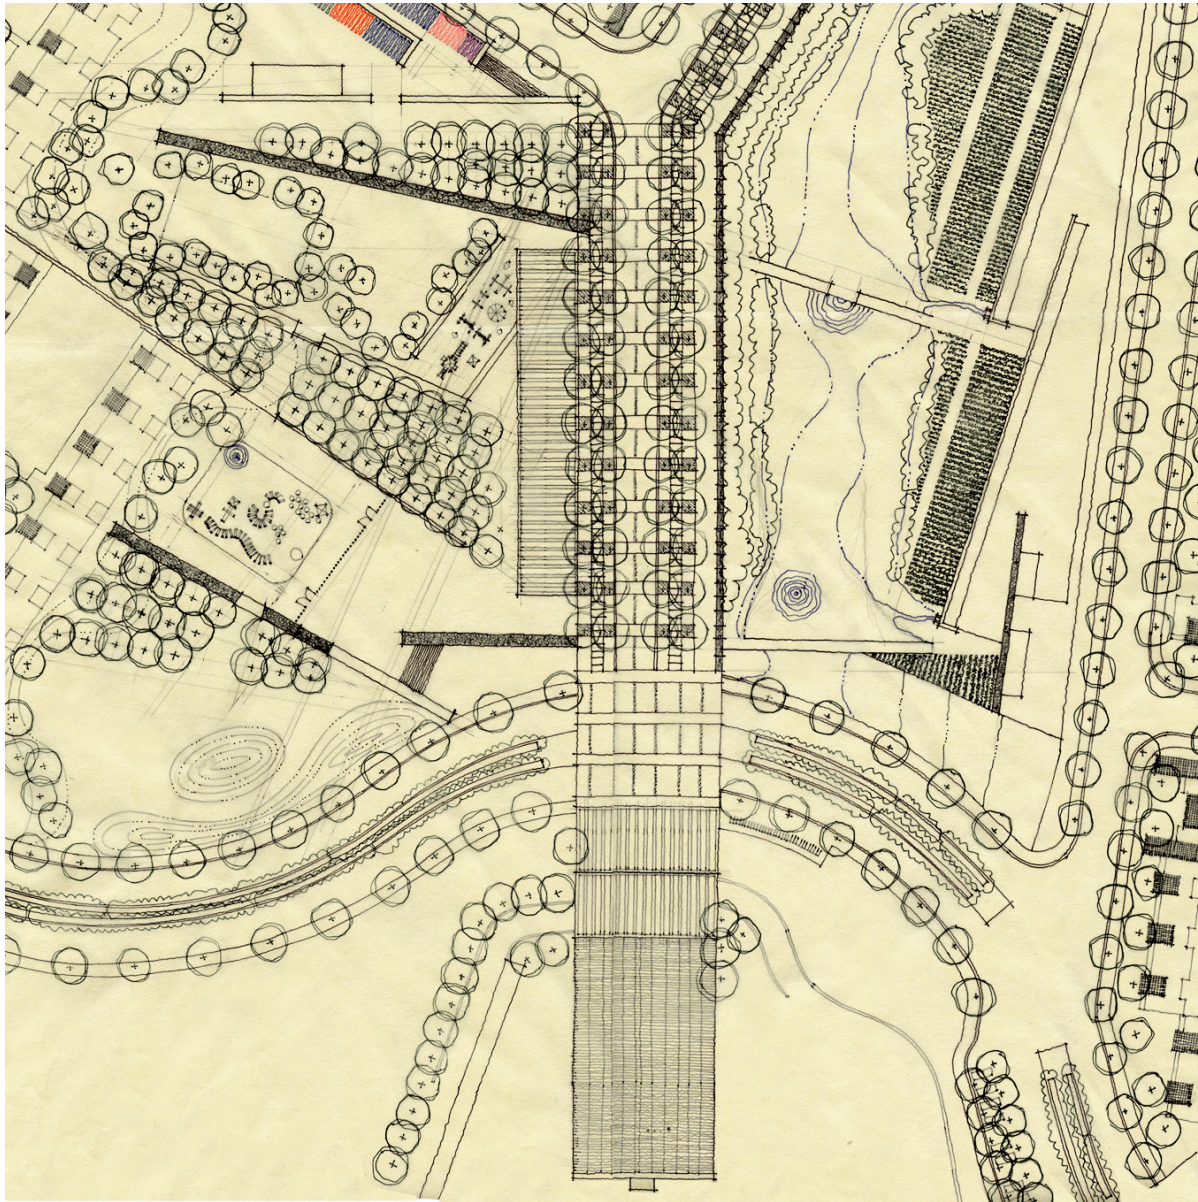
': Boceto de planta de conjunto Parque Rancho San Juan. (2010)
